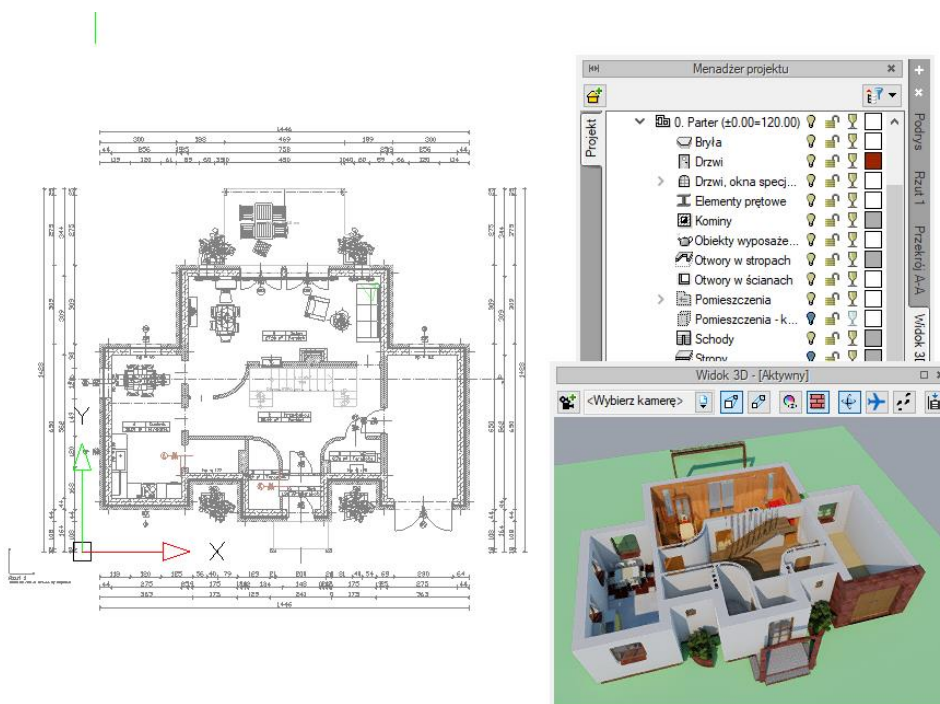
Przykład z aktywnym widokiem Widok 3D w trybie zaawansowanym
